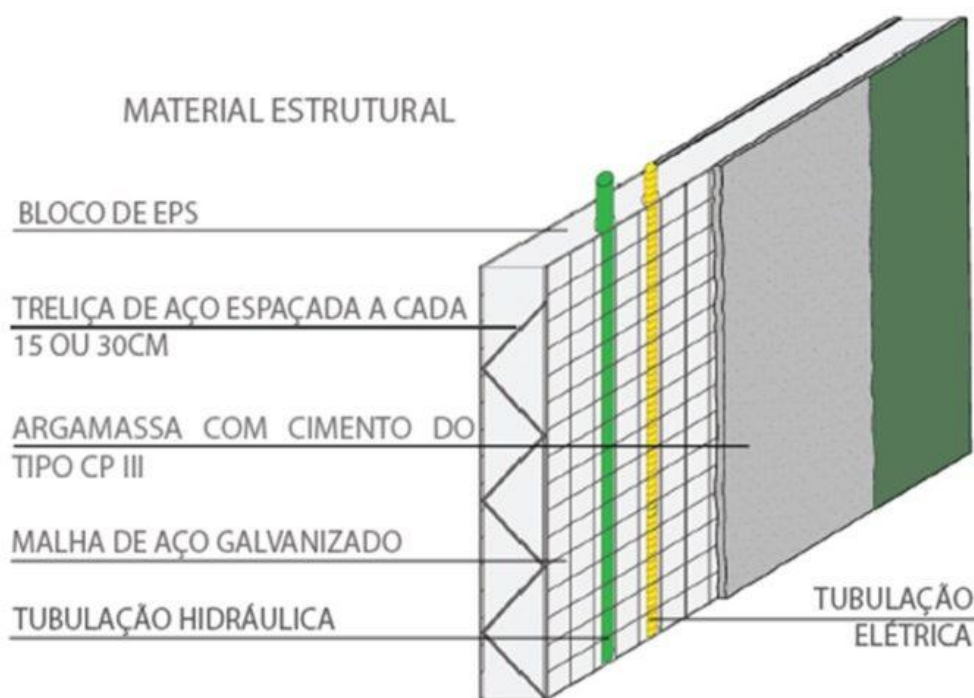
Sistema construtivo em painel de argamassa armada com miolo de EPS, chamado ECOGRIDE, da LCP Engenharia & Construções
